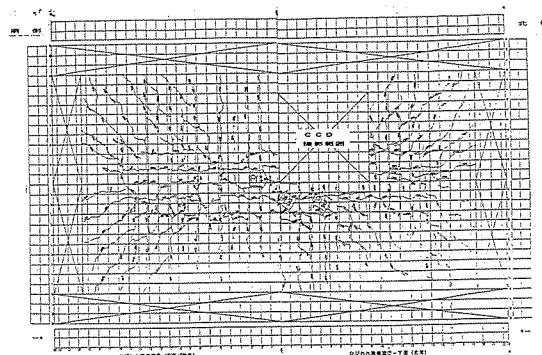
に移動載荷実験終了後の床版下面の目視によるひび割れ状況観察図を示す。床
